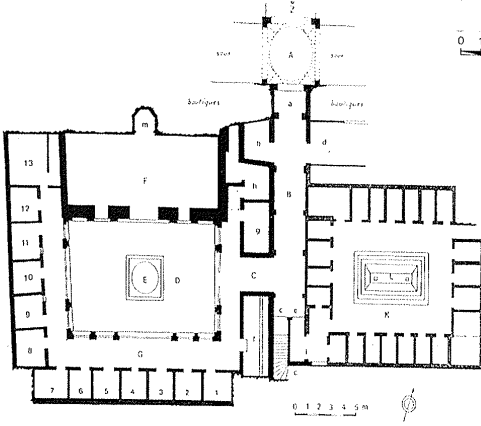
مسقط أفقي للدور الأرضي لمدرسة
